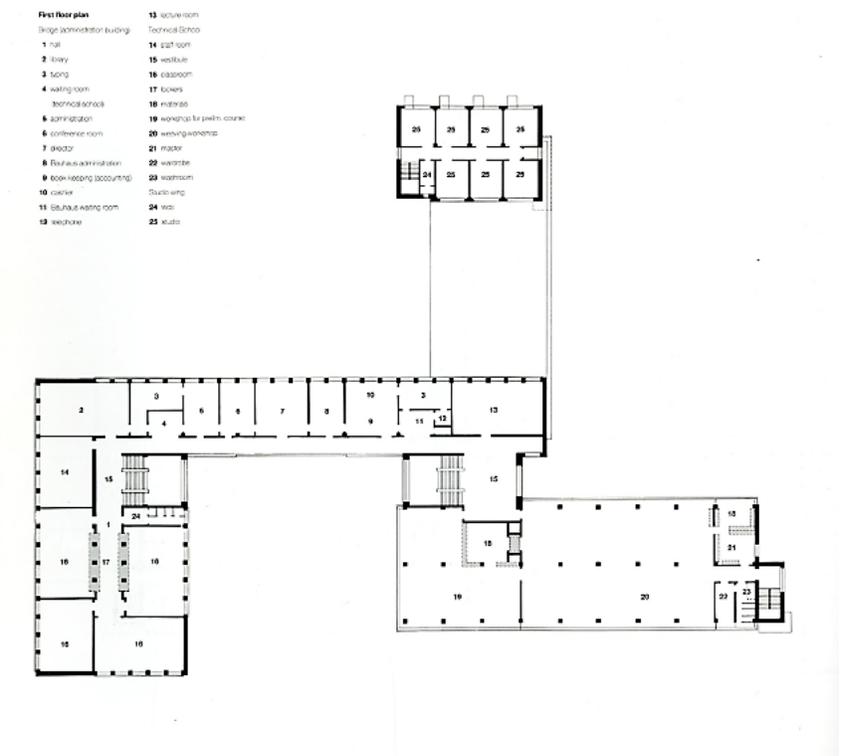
, Planta arquitectónica Nivel 2 de la Bauhaus. Plataforma Arquitectura. 2018
